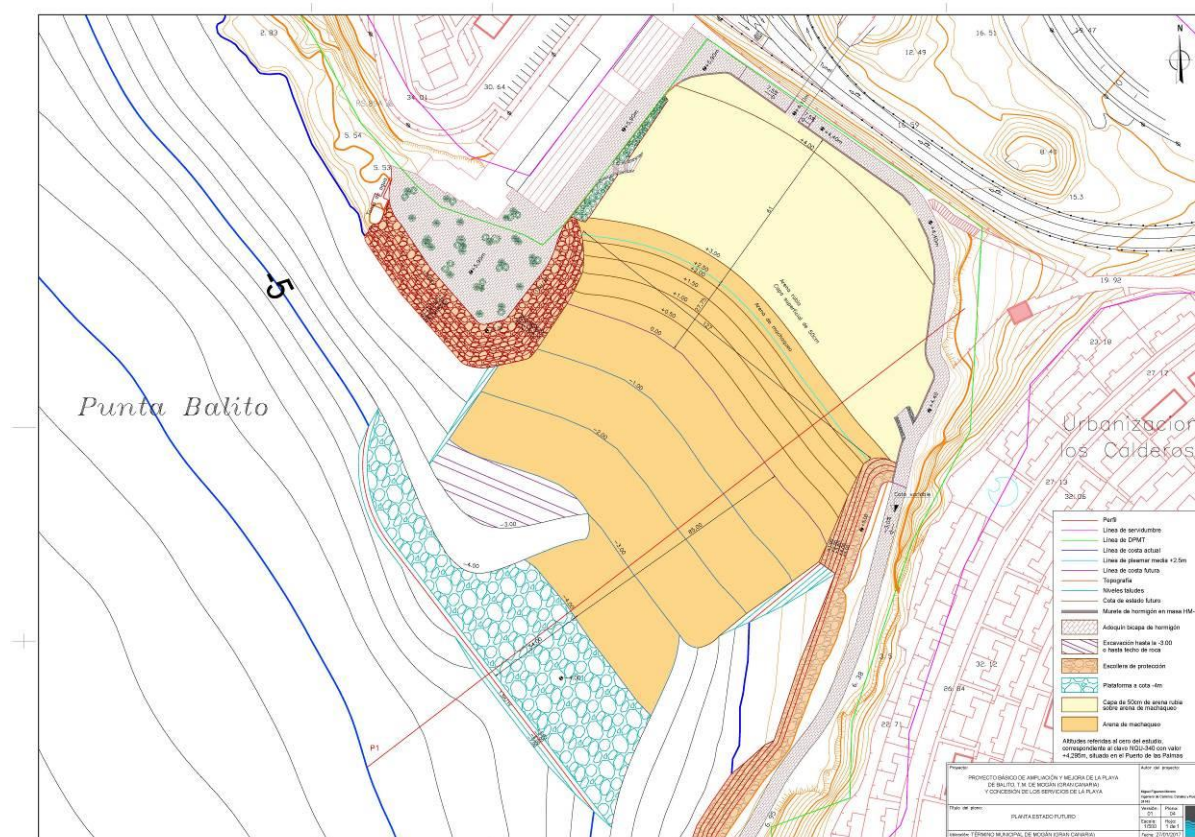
Planta del estado futuro de la playa de Balito tras la actuación
